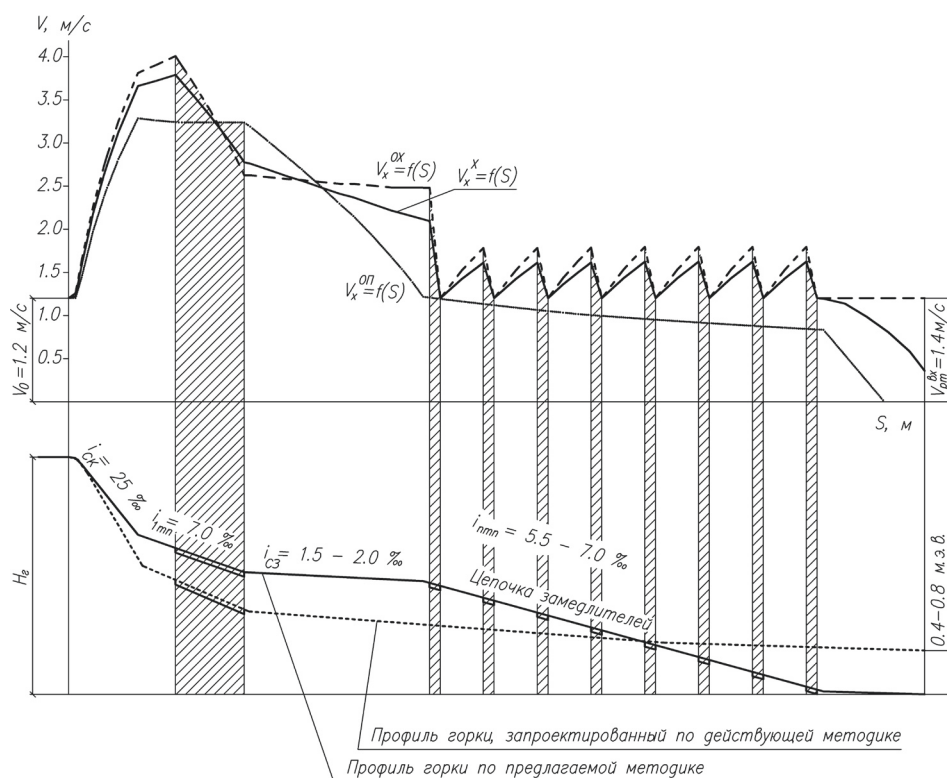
Профиль и кривые скорости скатывания отцепов для предлагаемой конструкции сортировочной горки:
